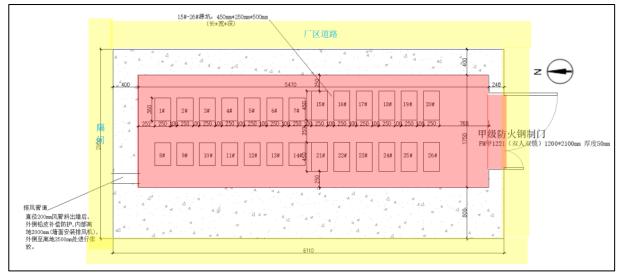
现有放射源暂存库扩容改造前平面布局图(单位: mm)
